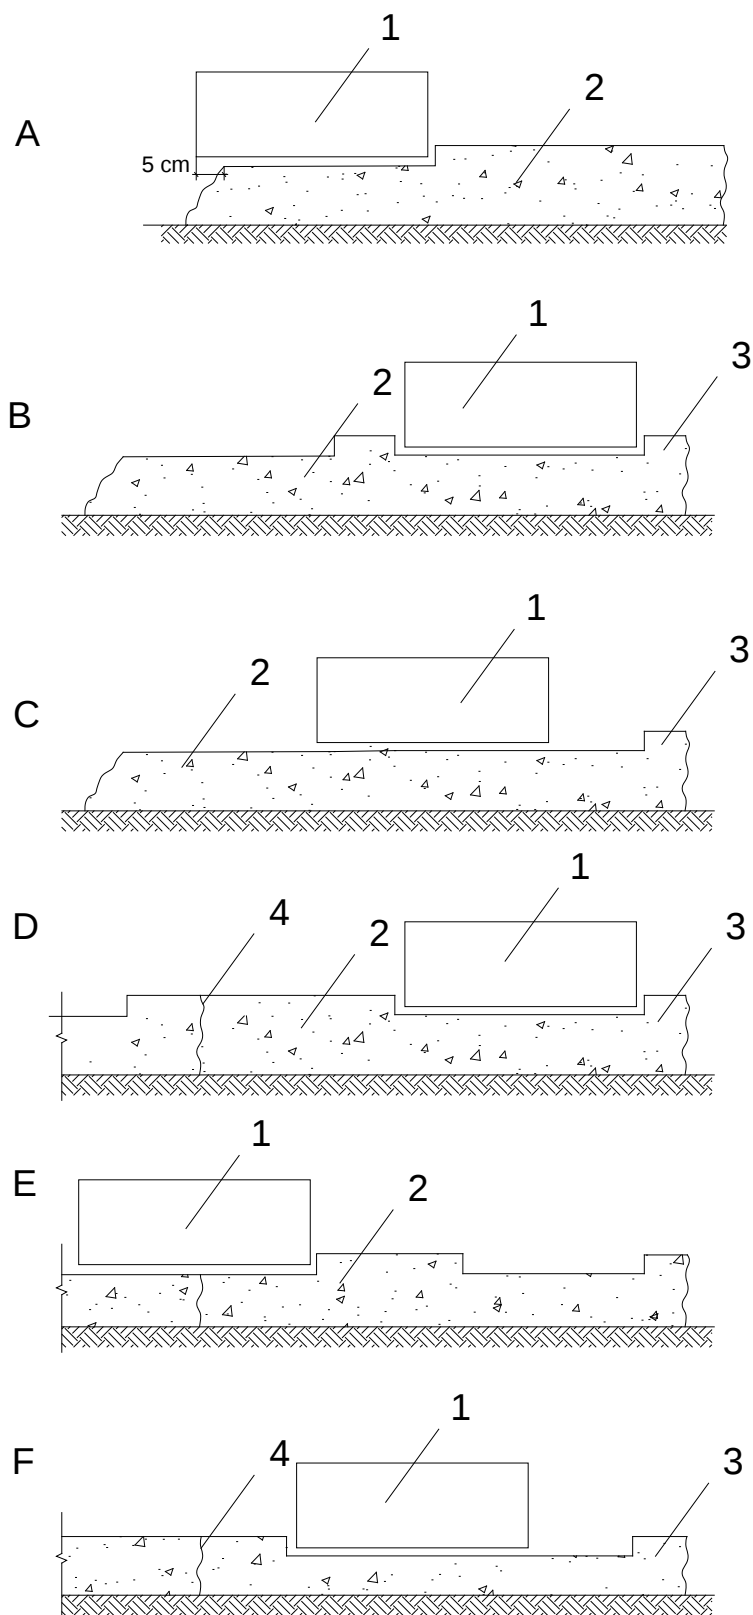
Schema de compactare a benzilor adiacente proaspăt așternute ale fundației din beton de ciment cilindrât (secțiunea transversală).
